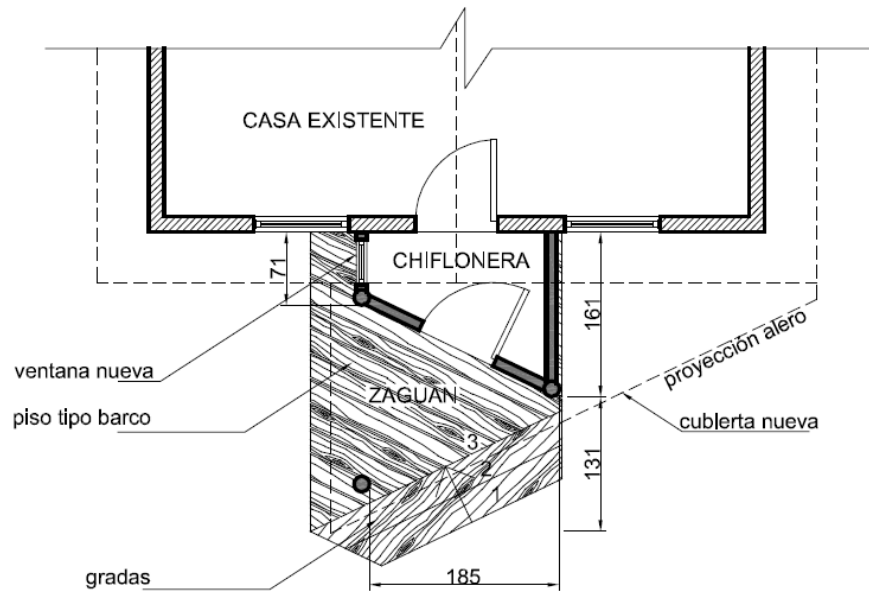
Planta tipo 1, situación propuesta, escala 1:50
